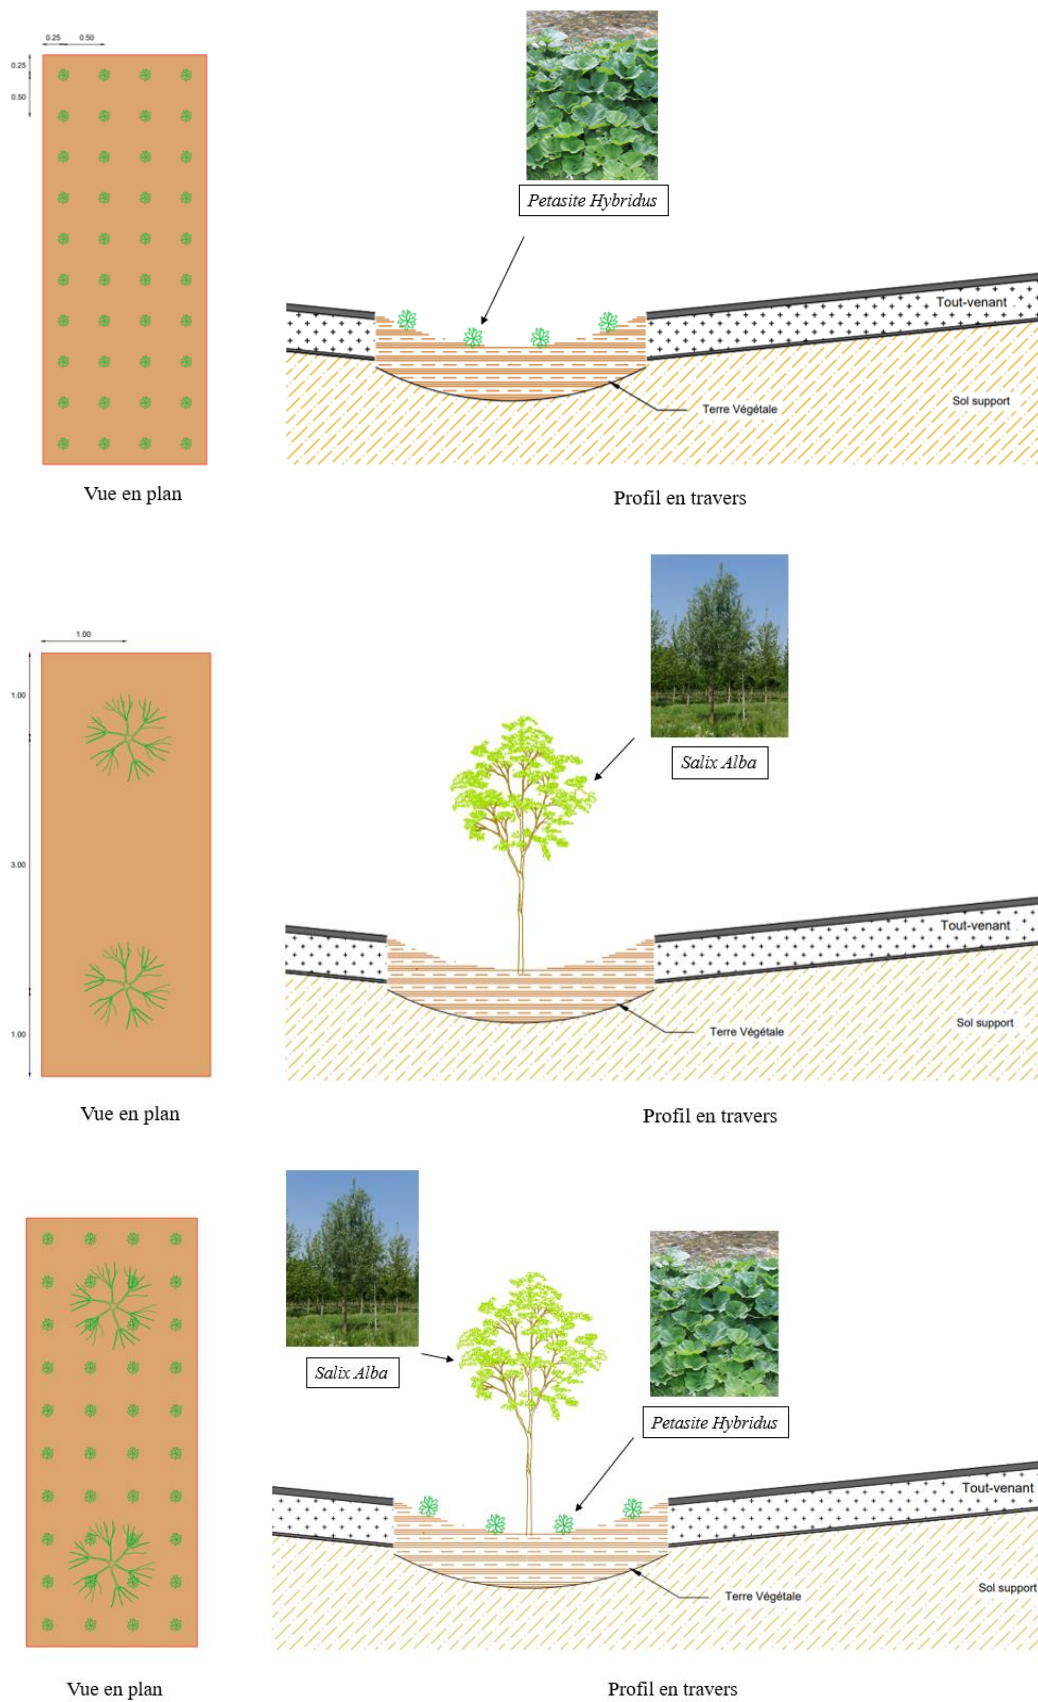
Vues en plan et profil en travers type de la mise en place de la végétation dans les noues
